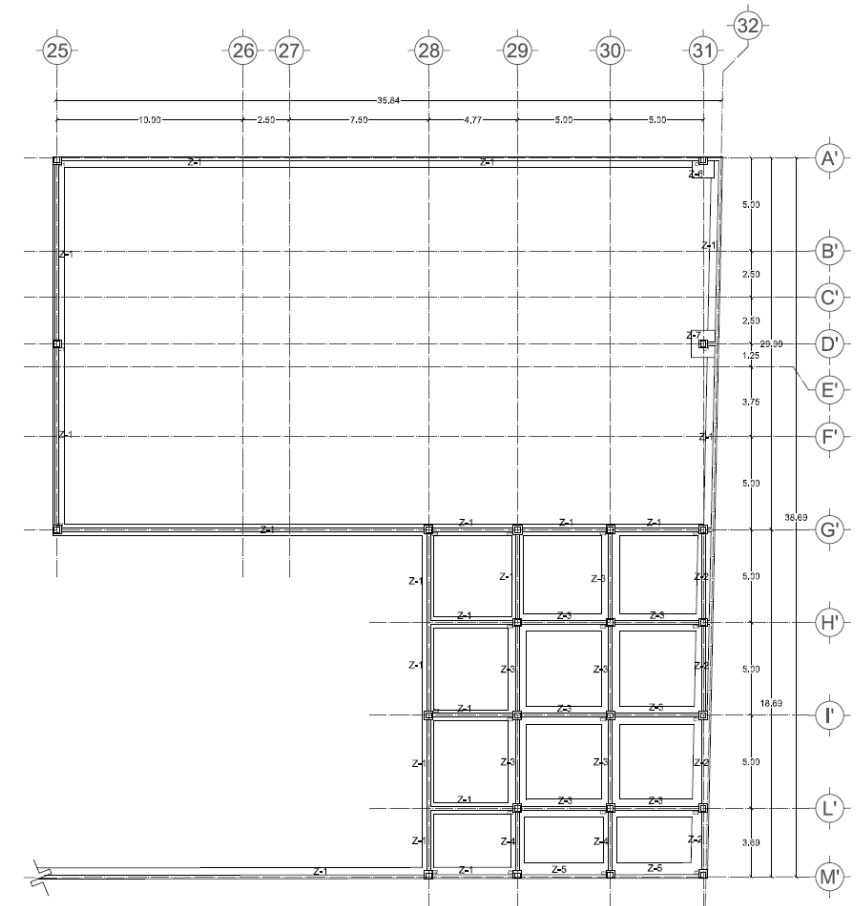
Planta de cimentación con zapatas corridas de la nave industrial.
